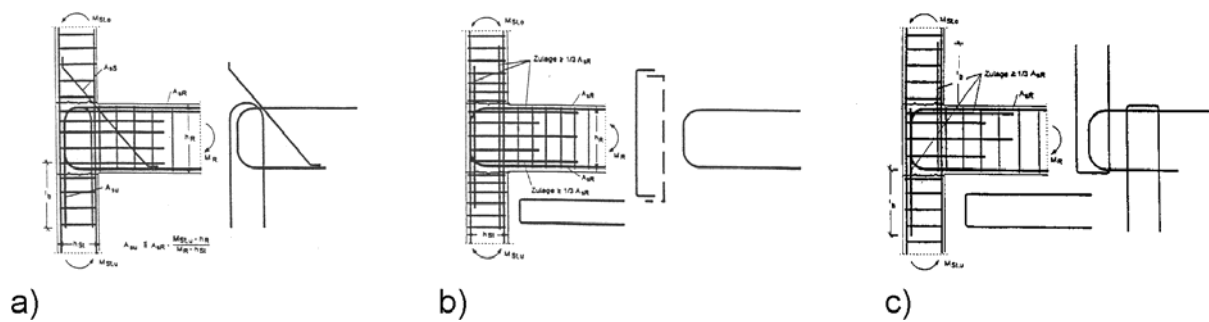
Empfehlung für die Bewehrung von Rahmenendknoten nach E DIN 1045-1, a) mit schlaufenartiger Bewehrungsführung mit Schrägstäben, b) mit Zulagen und c) bei wechselnder Momenten-Drehrichtung
